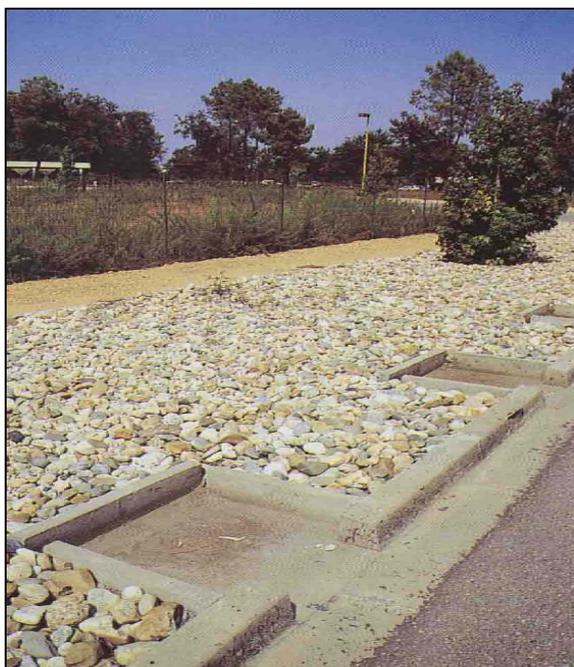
Exemples de tranchée d'infiltration le long d'un voirie
